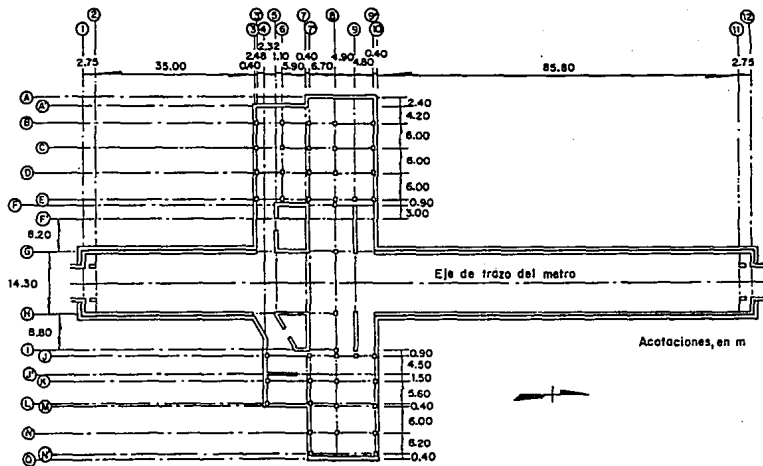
Planta de los cajones del Metro y de cimentación del edificio
